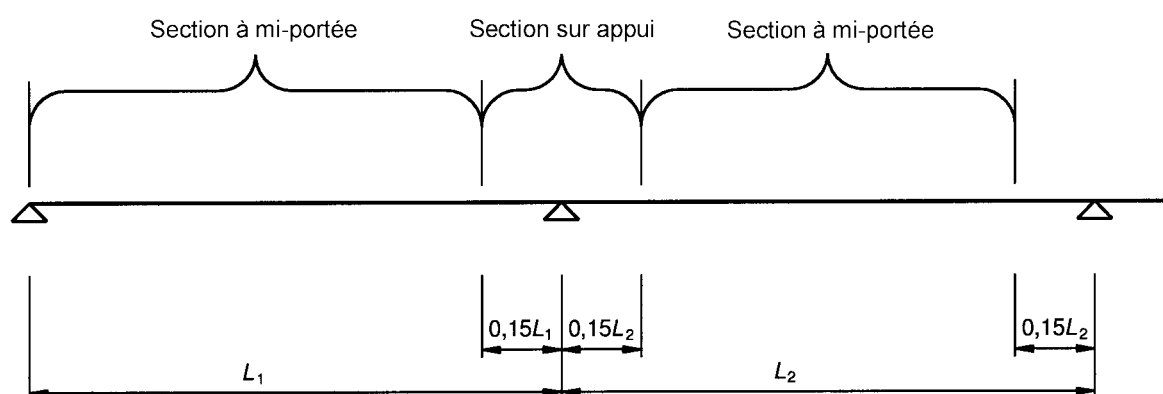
Emplacement d'une section à mi-portée ou d'une section sur appui
